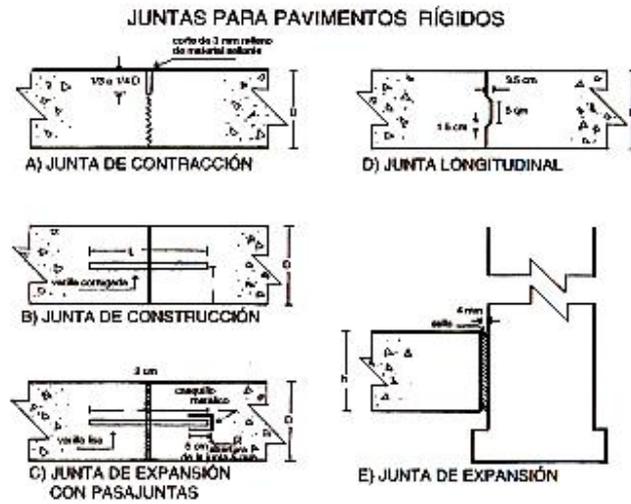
Diferentes juntas que se construyen en los pavimentos de concreto hidráulico.
